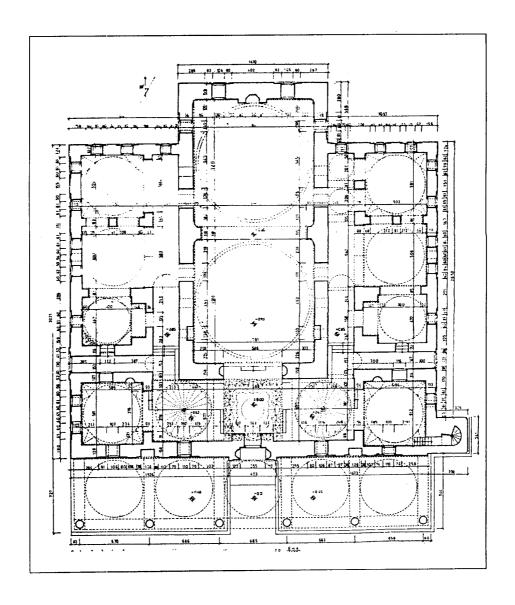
مسقط أفقي لمسجد عيسى بك في أسكوب (عن : ايفردى) .
